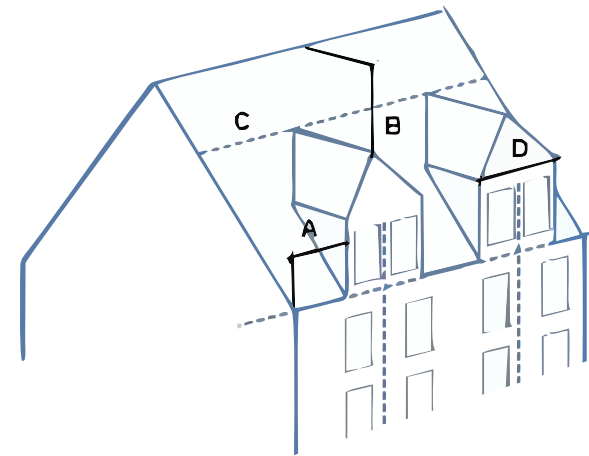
geeignete Anordnung von Dachaufbauten unter Berücksichtigung der Fassadengliederung und Einhaltung der Mindestabstände und Größenvorgaben
